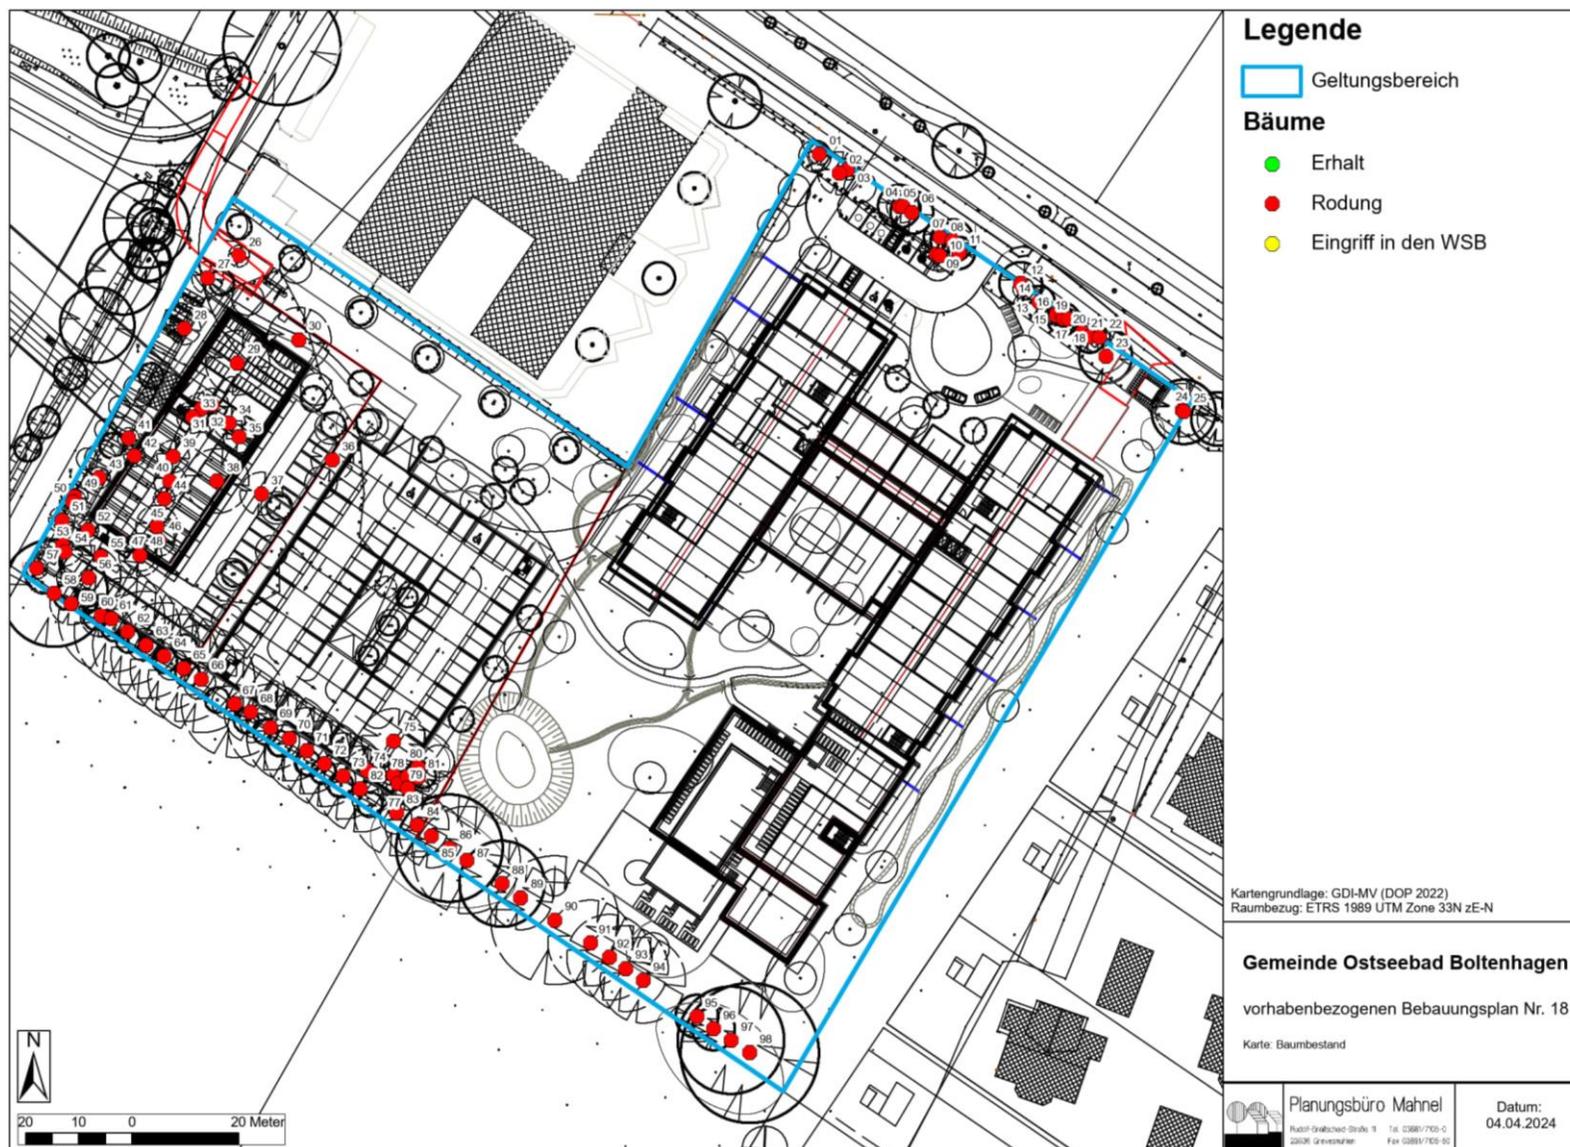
Variante 3: Bestand mit Eingriff in den Baumbestand
